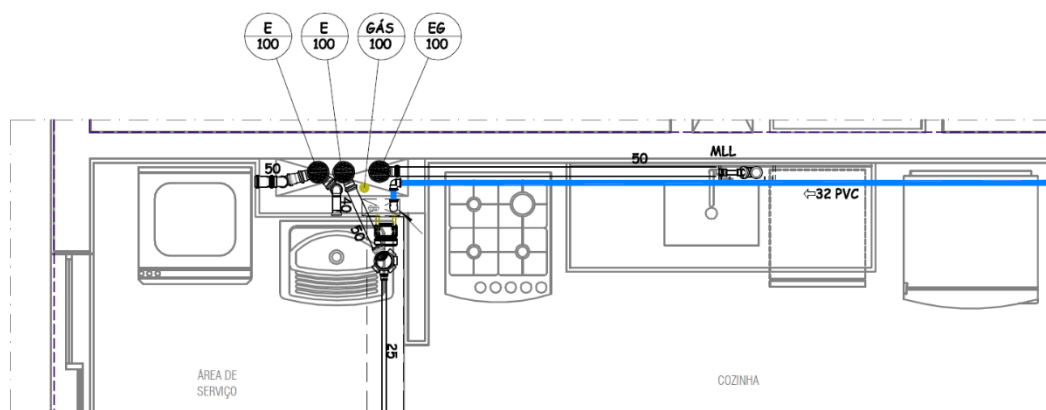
Projeto executivo de ramais e sub-ramais de esgoto sanitário.
